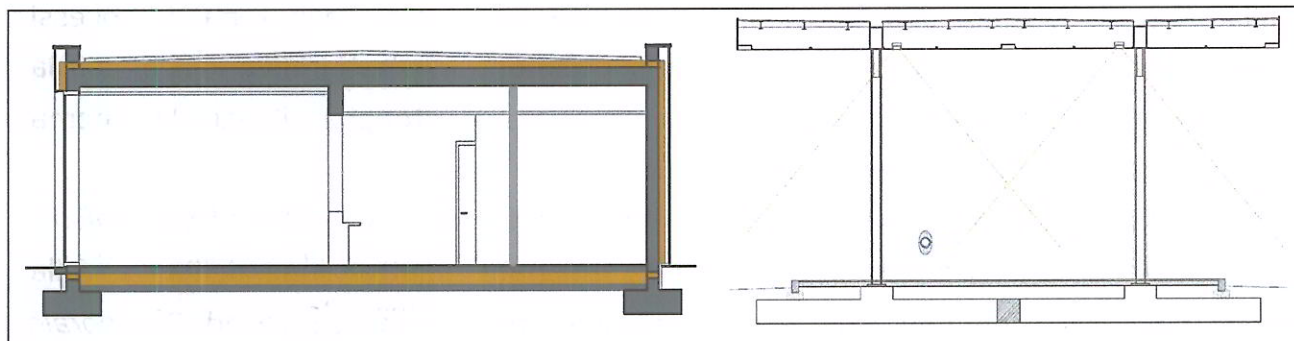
sezioni indicative di progetto – biglietteria a sx e pensilina a dx
